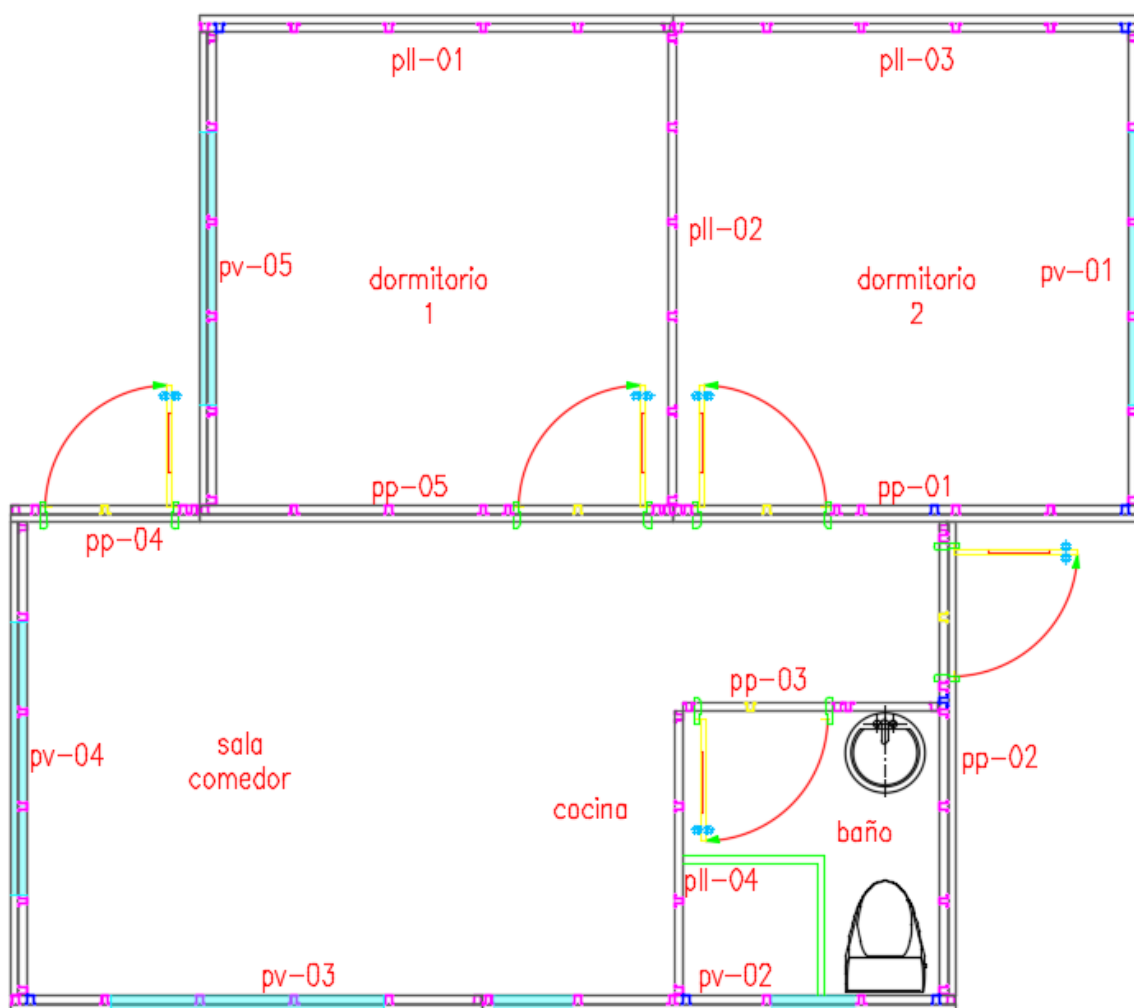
Planta Arquitectónica Modulada e Identificación de Paneles
